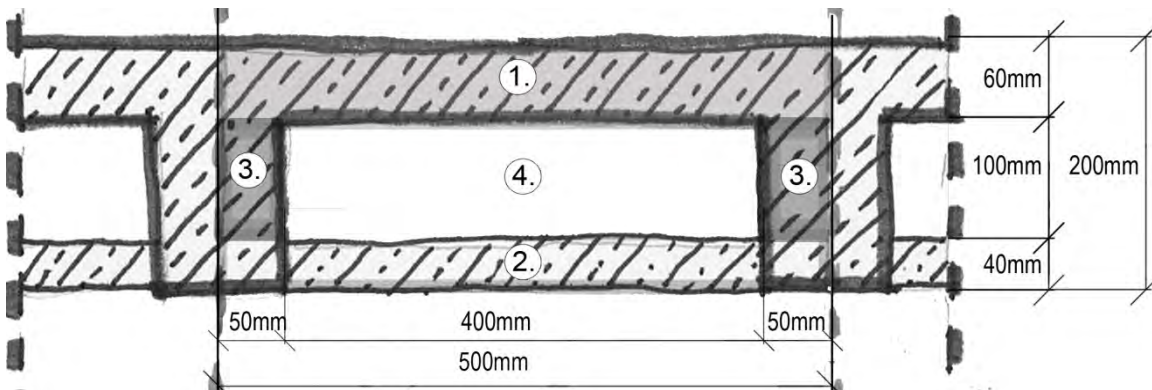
Probenabschnitt Hohlraumdecke Bestand_20cm_6cm
